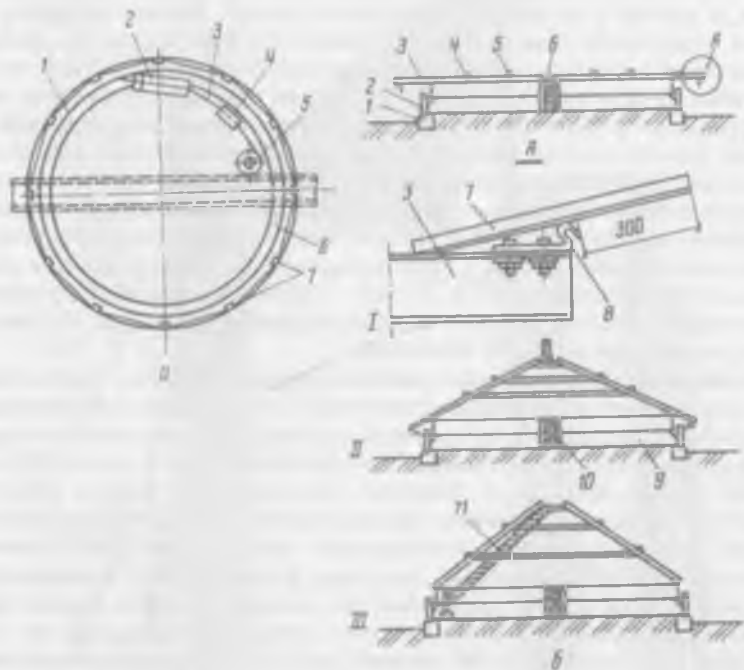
Возведение металлических силосов диаметром 18 м методом навивки:
